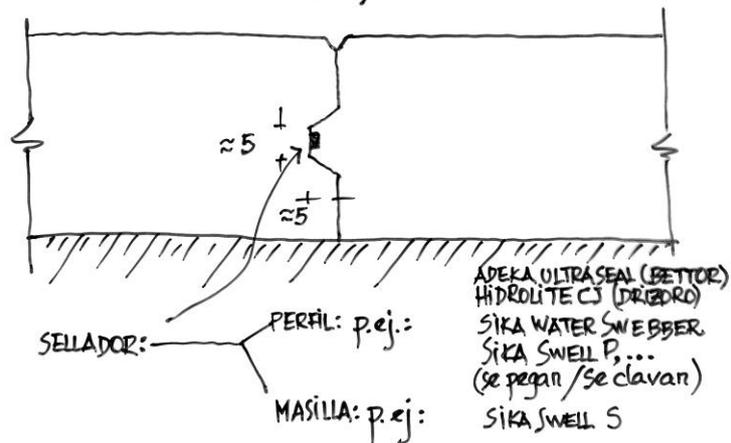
Esquema de junta de retracción de hormigonado de muro in situ con cordón sellador hidrófilo
